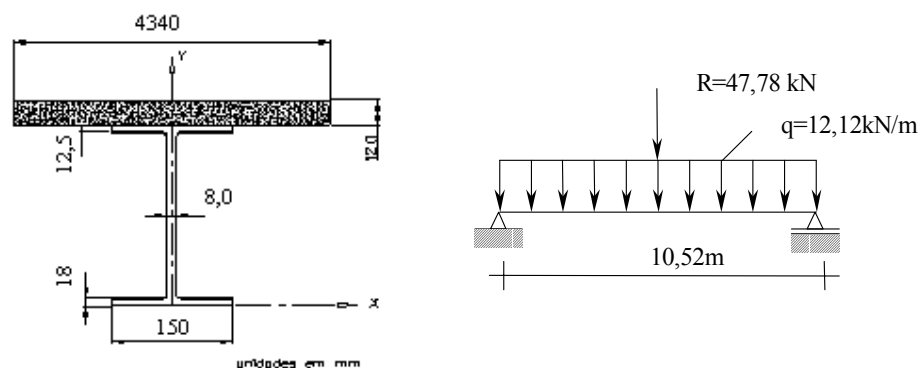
Seção transversal e esquema estrutural da viga V14
